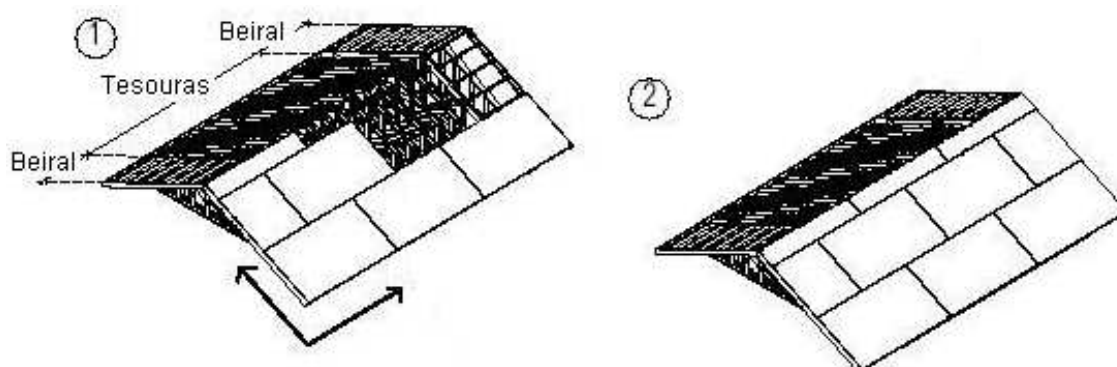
Travamento das tesouras por diafragma de enrijecimento com placas de OSB ou multilaminado fenólico (Fonte: IAS, 2003)
